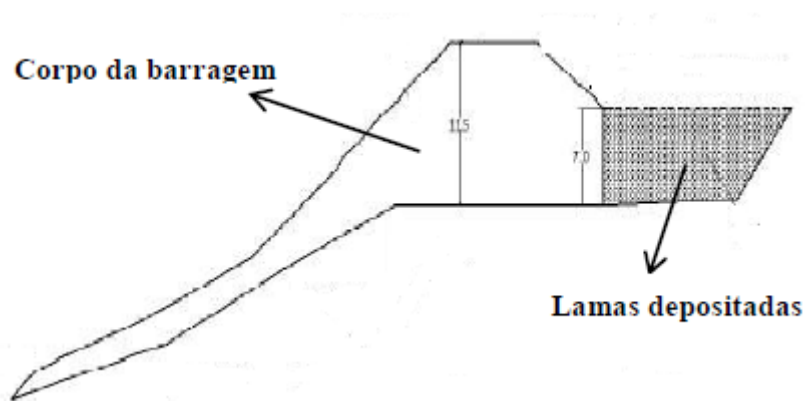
Perfil longitudinal da barragem das minas da Fonte Santa (adaptado de DUQUE, 2011).
